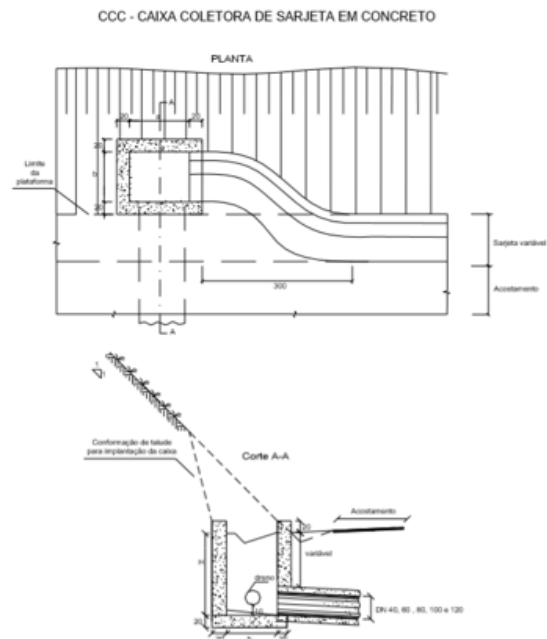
Caixa Coletora de Sarjeta em Concreto – CCC
